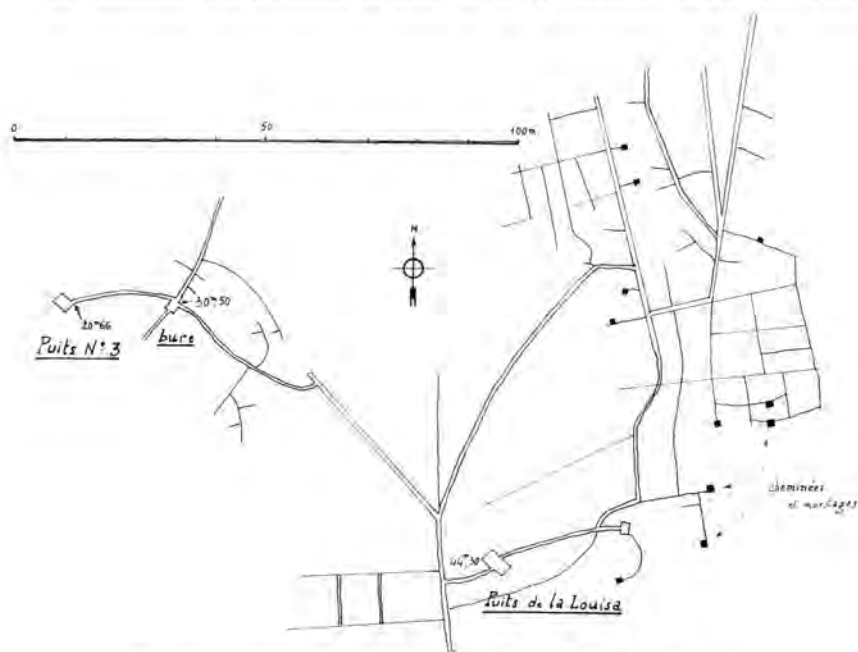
Plan des travaux de la Louisa au niveau -44
